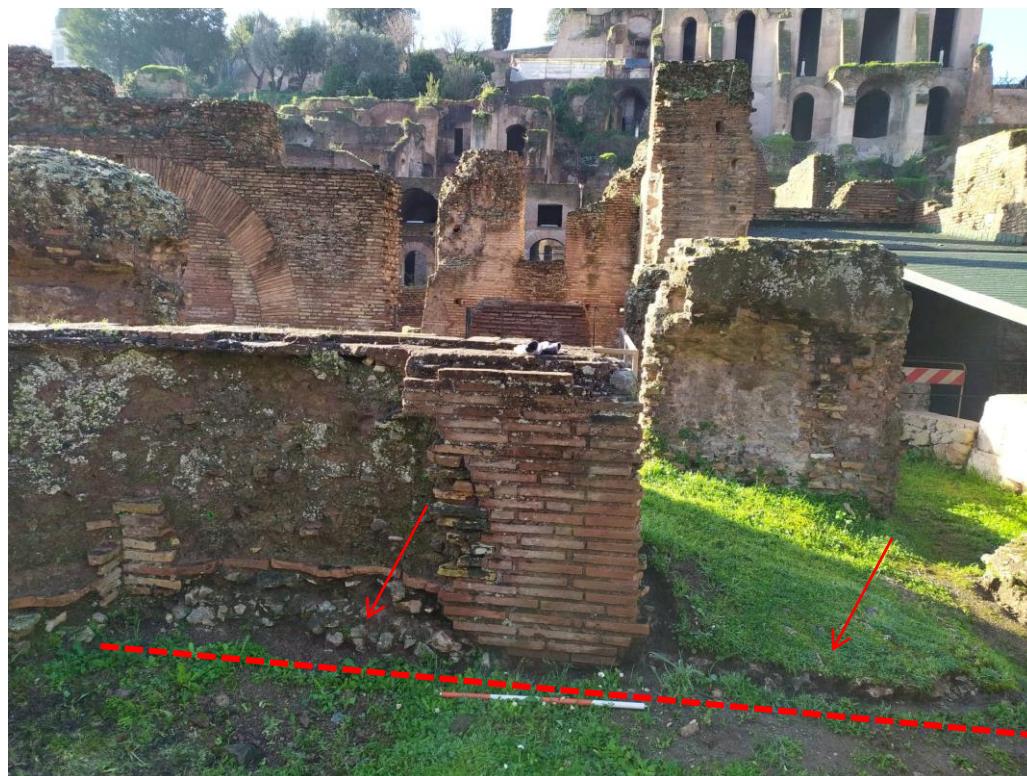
\_Area P, muro perimetrale sud. La linea indica l'andamento della fondazione neroniana.
